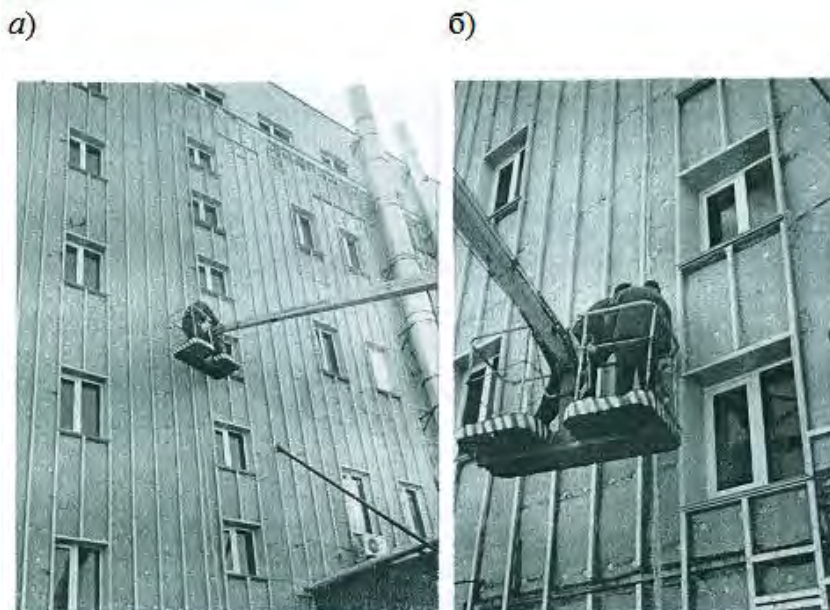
Измерительный участок на стене с «вентилируемым фасадом» административного здания:
